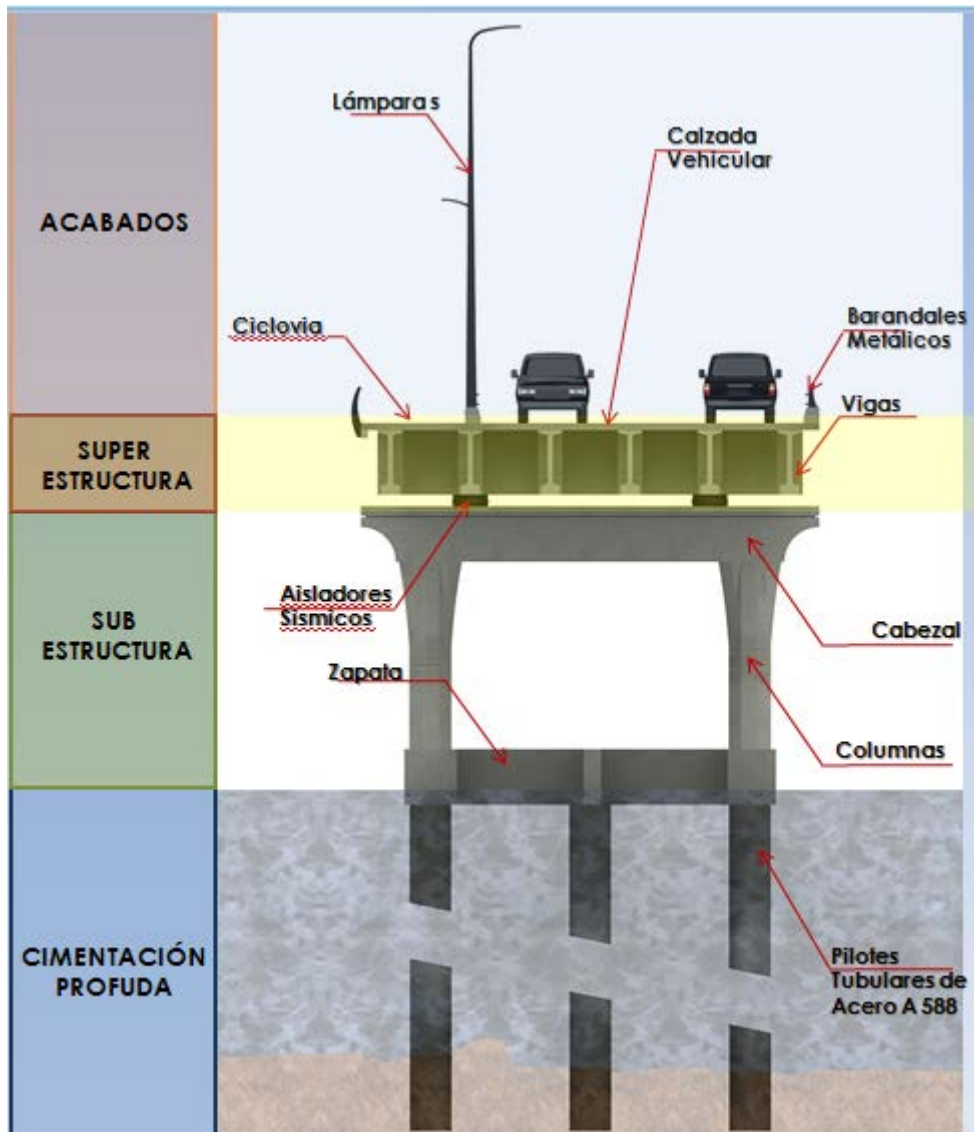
Sección Transversal de Puente Tipo (Fuente CEE)
